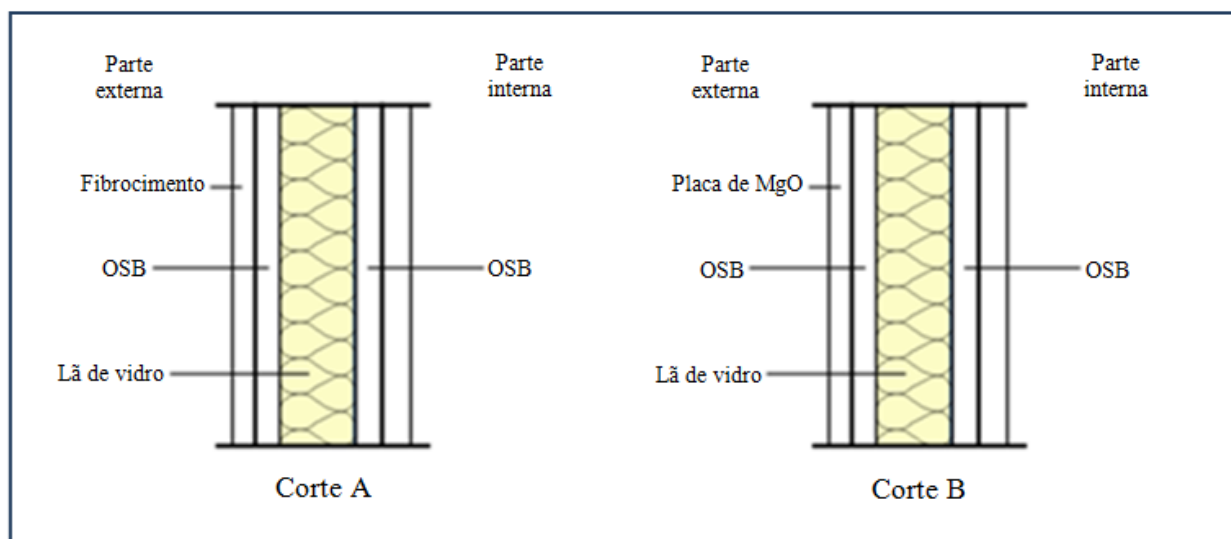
Detalhes construtivos: (a) Painel construído com placa de fibrocimento Portland e (b) Painel construído com placa à base de óxido de magnésio.
